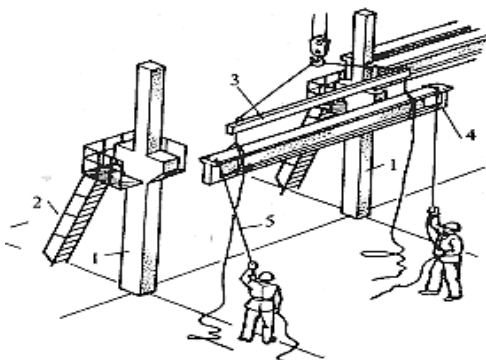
Схема организации рабочего места при установке подкрановой балки:
